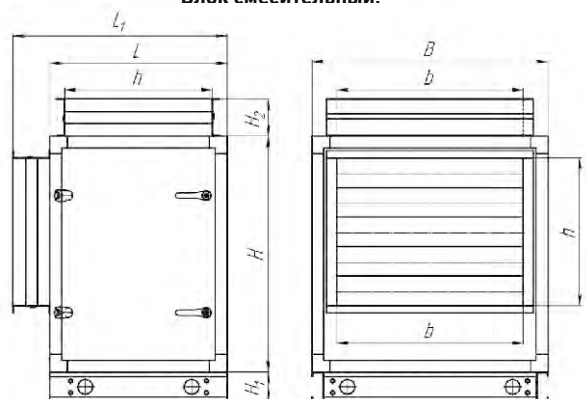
Габаритные и присоединительные размеры. Блок смесительный.
